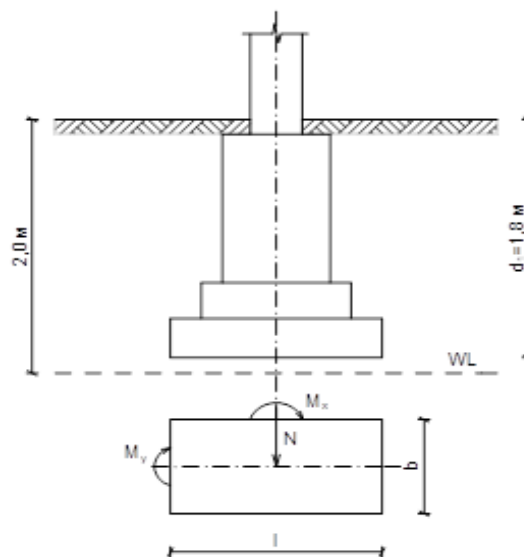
Схема розташування фундаменту у ґрунті і навантажень на фундамент
